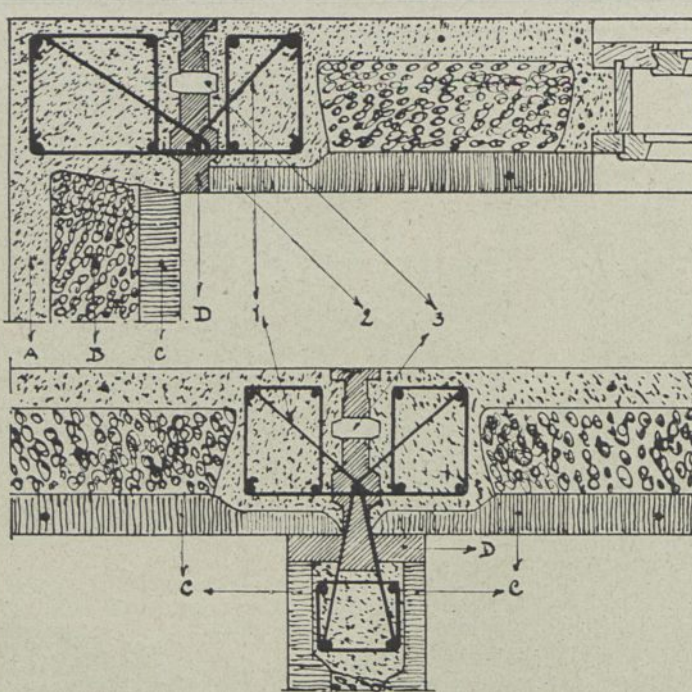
Wandkonstruktion der „Occident“-Bauweise (armierte Betonplatte, außen Riesbeton; in der Mitte Schlackenfüllung, innen Schlackenbeton).
